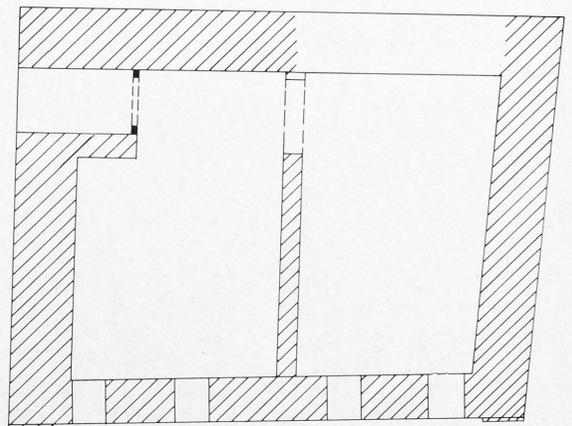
Grundriß des Urbaus (Arkensches Burghaus) – Erd-geschoß
